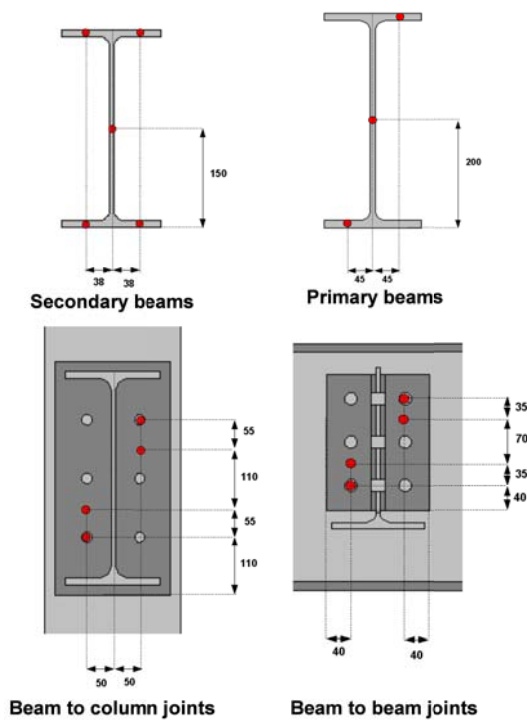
Position des thermocouples sur chaque section droite des assemblages métalliques instrumentés
